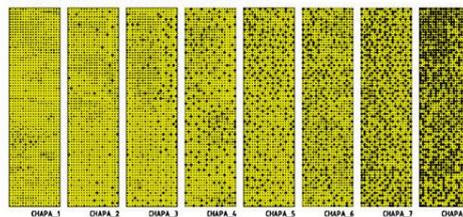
PADRÕES METAIS DAS FACHADAS
